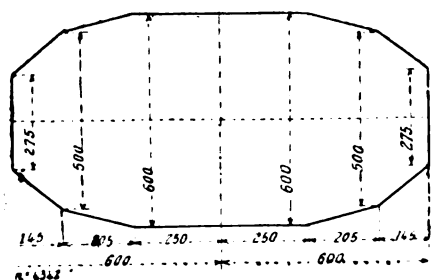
Coupe longitudinale d'un solide d'essai de forme parabolique.
